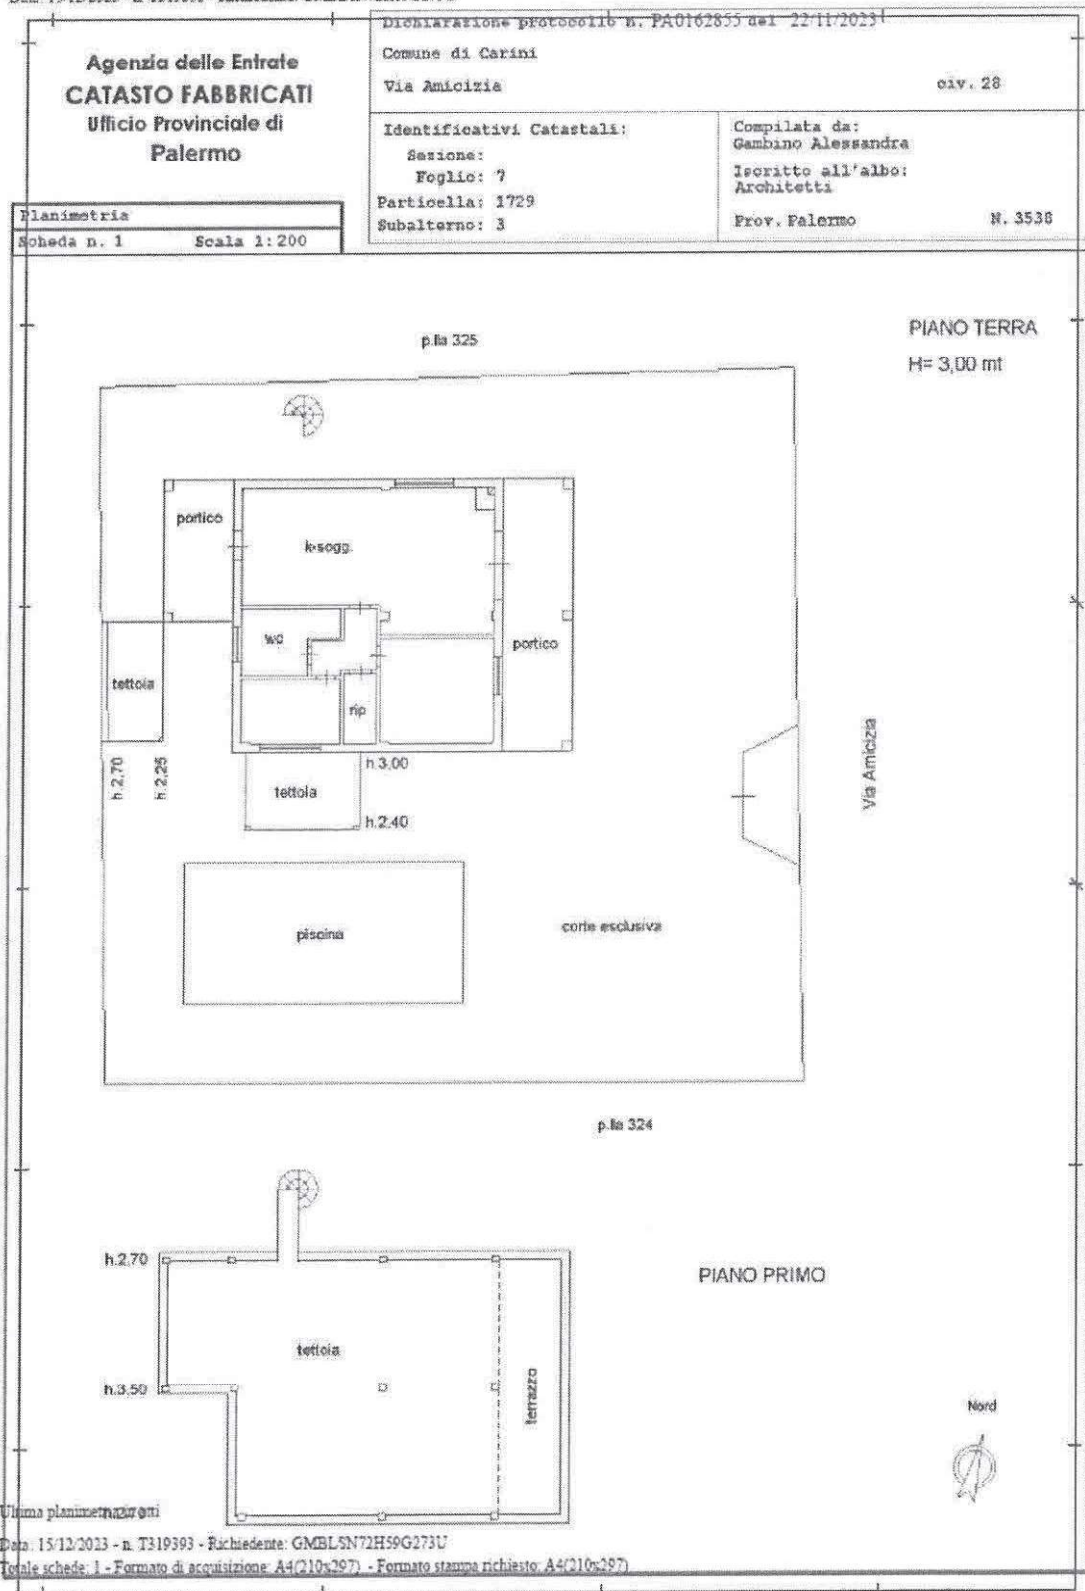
is Planimetria catastale attuale sub 3 (soppressione dei sub 1 e 2.) dopo l'aggiornamento catastale del 20/11/2023
